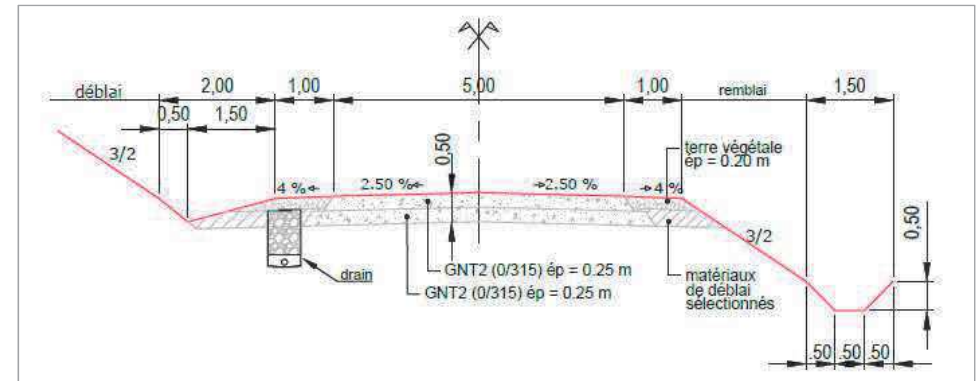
Profil en travers type de la voie de Boissac (VC n°8)
